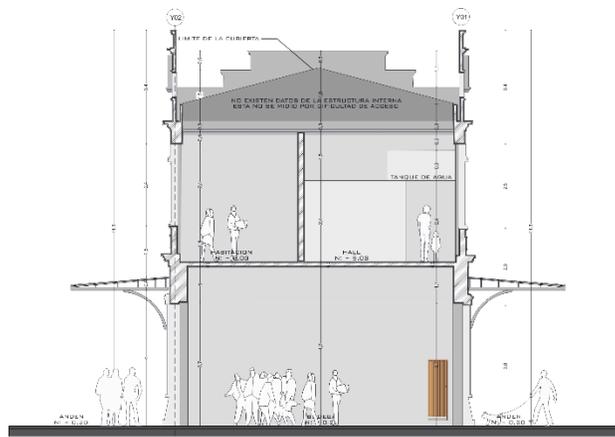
Sección transversal B-B, Estación del ferrocarril Sur.
